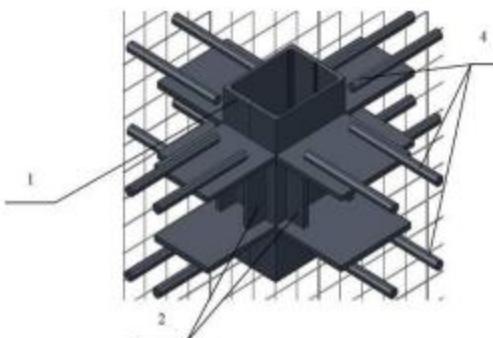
Металеві конструкції вузла з'єднання монолітної залізобетонної безбалковими плитами зі сталезалізобетонною колоною [13]:
